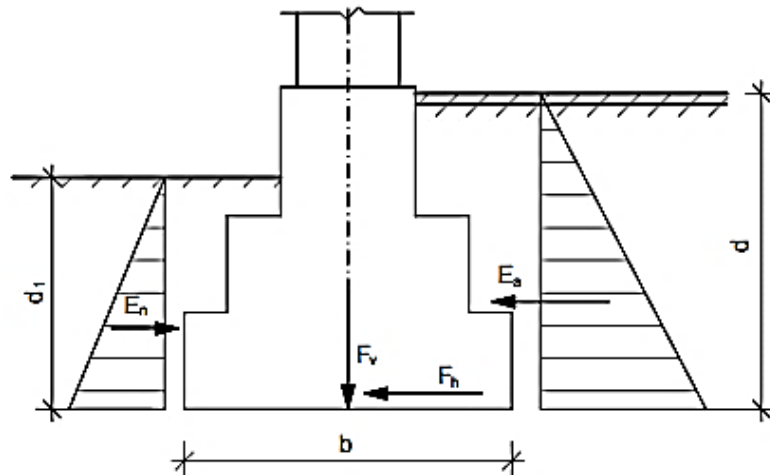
Розрахункова схема для розрахунку фундаменту на зсув по підшві
